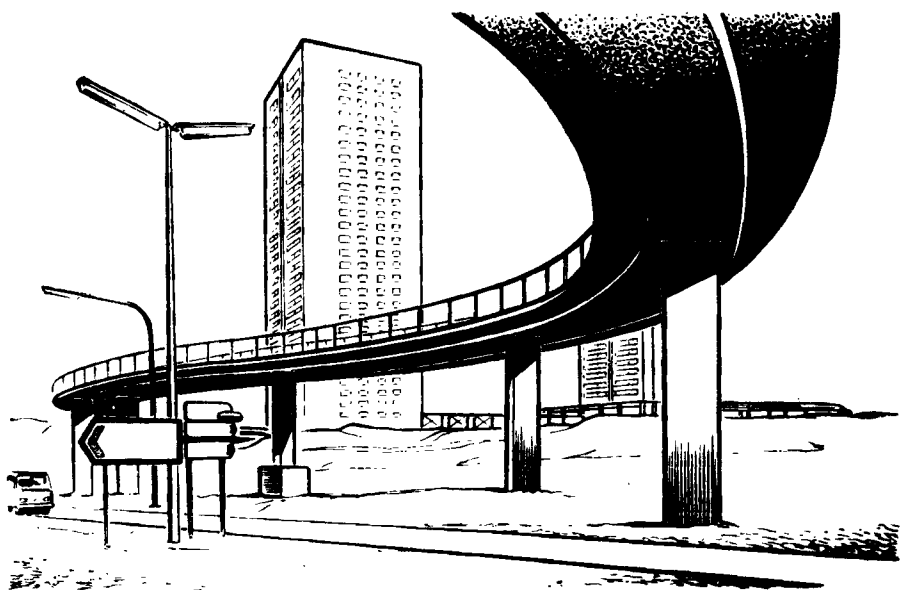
Криволинейный железобетонный пешеходный мост
